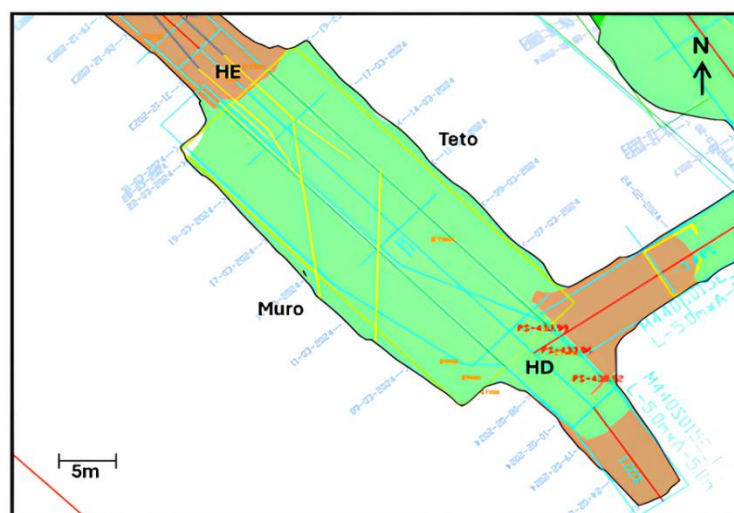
Planta da bancada em estudo do jazigo do Moinho, no piso 440 (adaptado de Documentação interna: gentilmente cedida pela ALMINA - minas do Alentejo S.A.).
